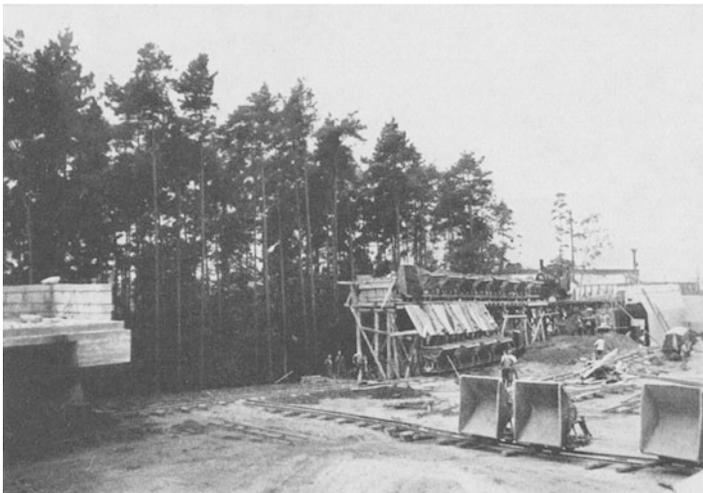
Die Gerüstschüttung. Die Massen werden vom Gerüst durch Wagen zur Einbaustelle gebracht (starrer Förderbetrieb).
